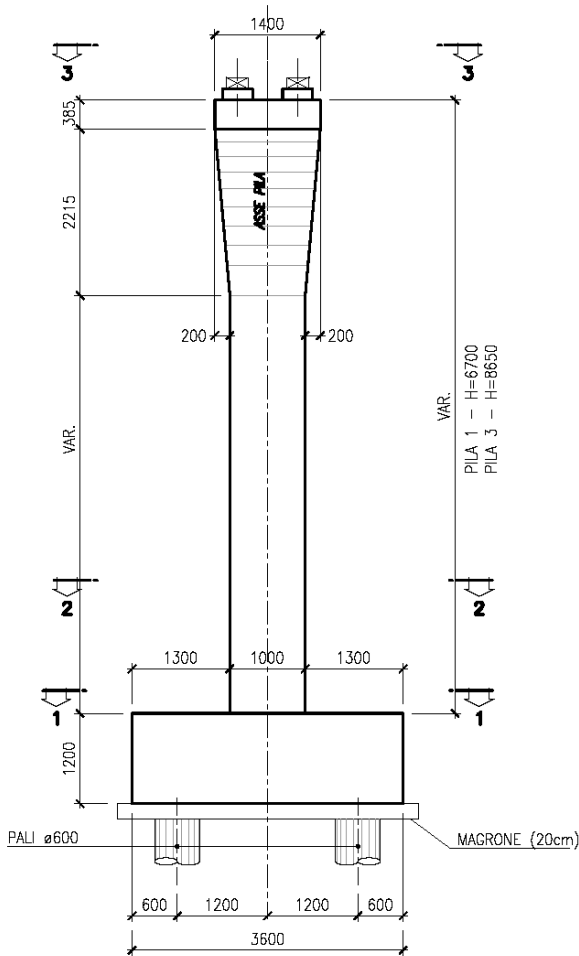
Fondazione pile 2 e 3 - Geometria [mm]
